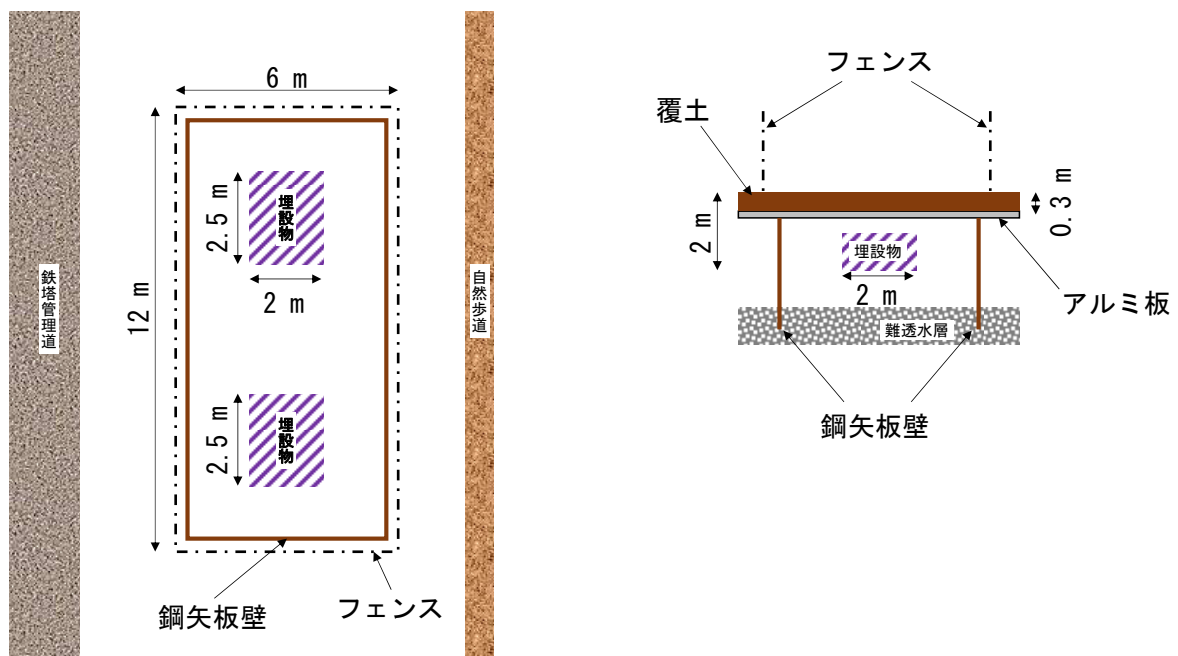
埋設状況想定図（左：平面図，右：断面図）
